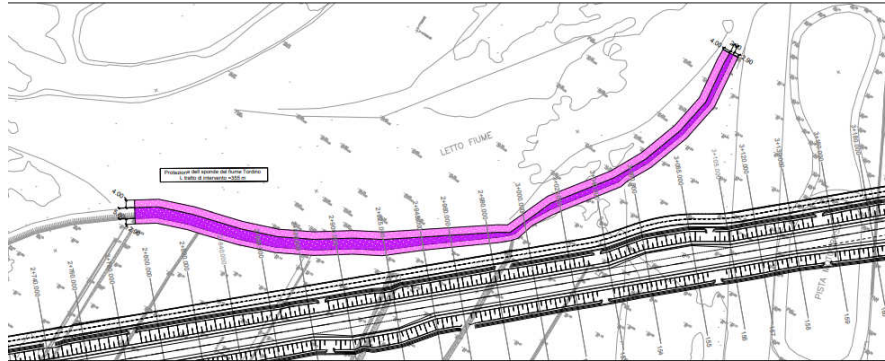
Stabilizzazione e protezione con massi naturali della sponda soggetta ad erosione spondale
